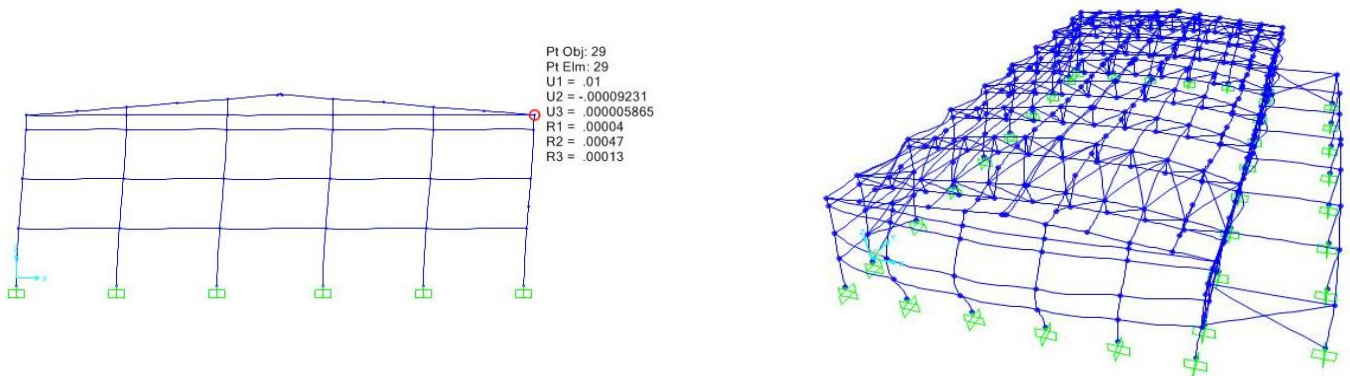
Deformada de la estructura bajo la acción del viento Vx1b (SAP2000).
